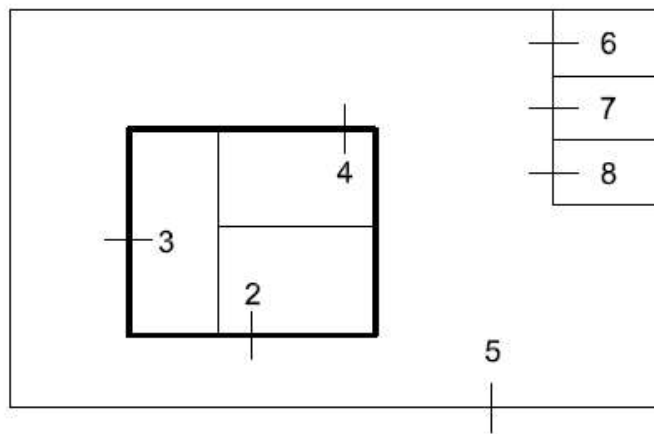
Elaborato planimetrico non quotato dopo il frazionamento
